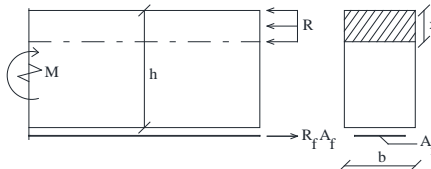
Расчетная схема кладки из плоскости при наличии внешнего армирования.
